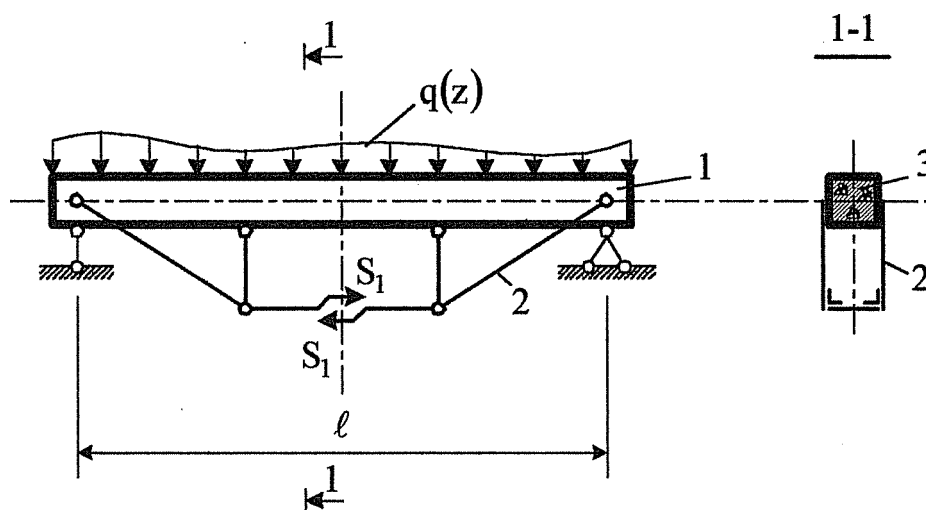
Конструкция сталебетонной балки, усиленной шпренгелем
